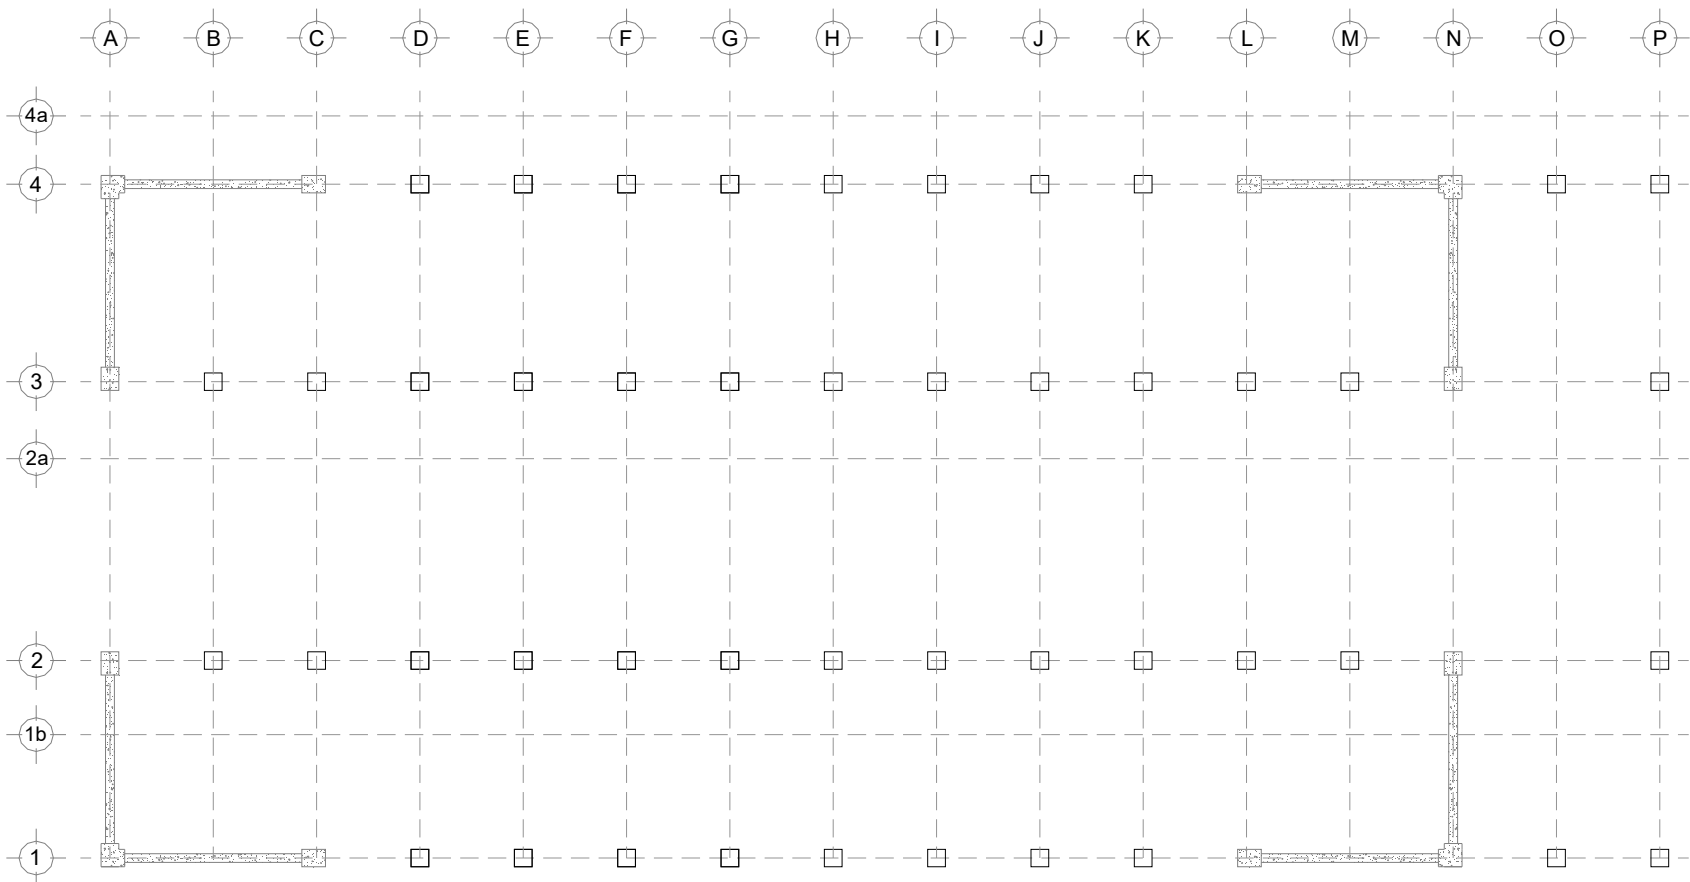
Configuración de muros de corte en planta estructural. Modelo de Hospital.
